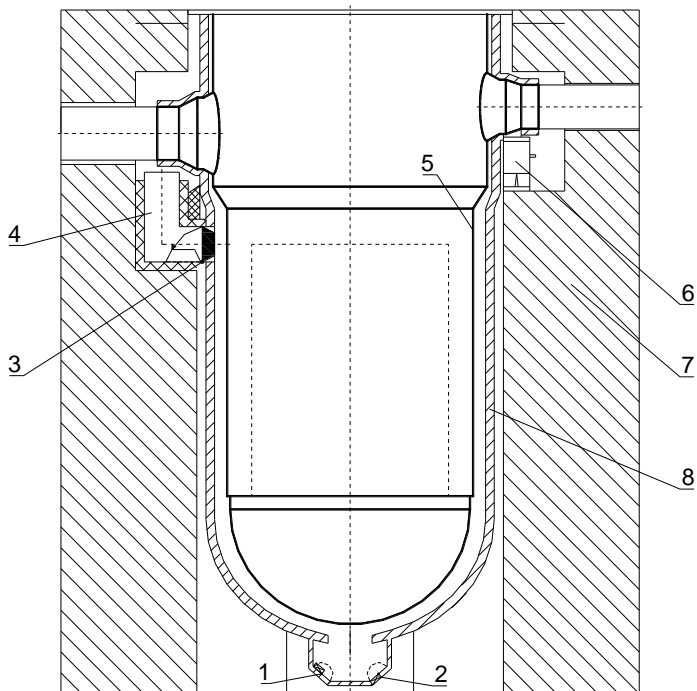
Система изоляции корпуса реактора AP-1000: 1 – петля, 2 – заслонка, 3 – заслонка для выхода пара, 4 – выход пара (4 трубопровода), 5 – корпус реактора, 6 – опорная плита корпуса реактора, 7 – шахта реактора, 8 – изоляция
